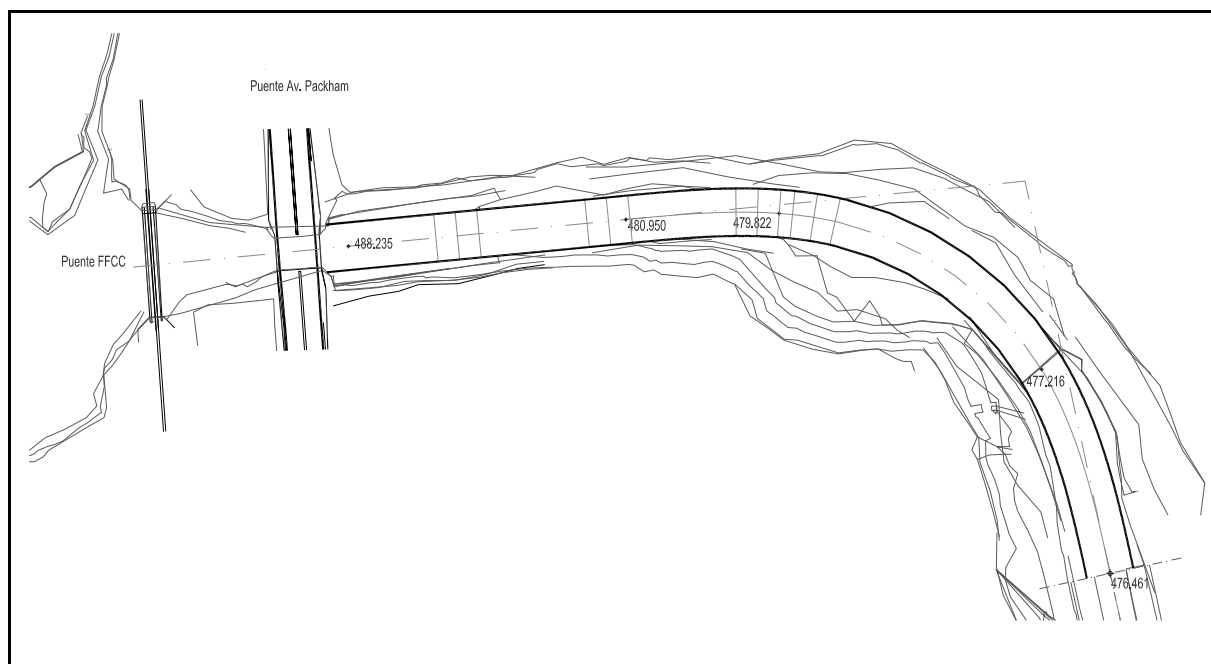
Plano en planta de la obra analizada en la etapa de diagnóstico
